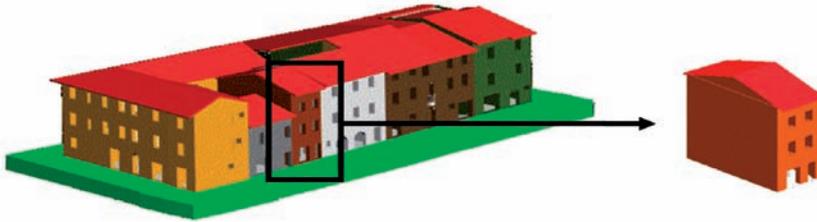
Individuazione US (Unità Strutturale) all'interno dell'aggregato.
